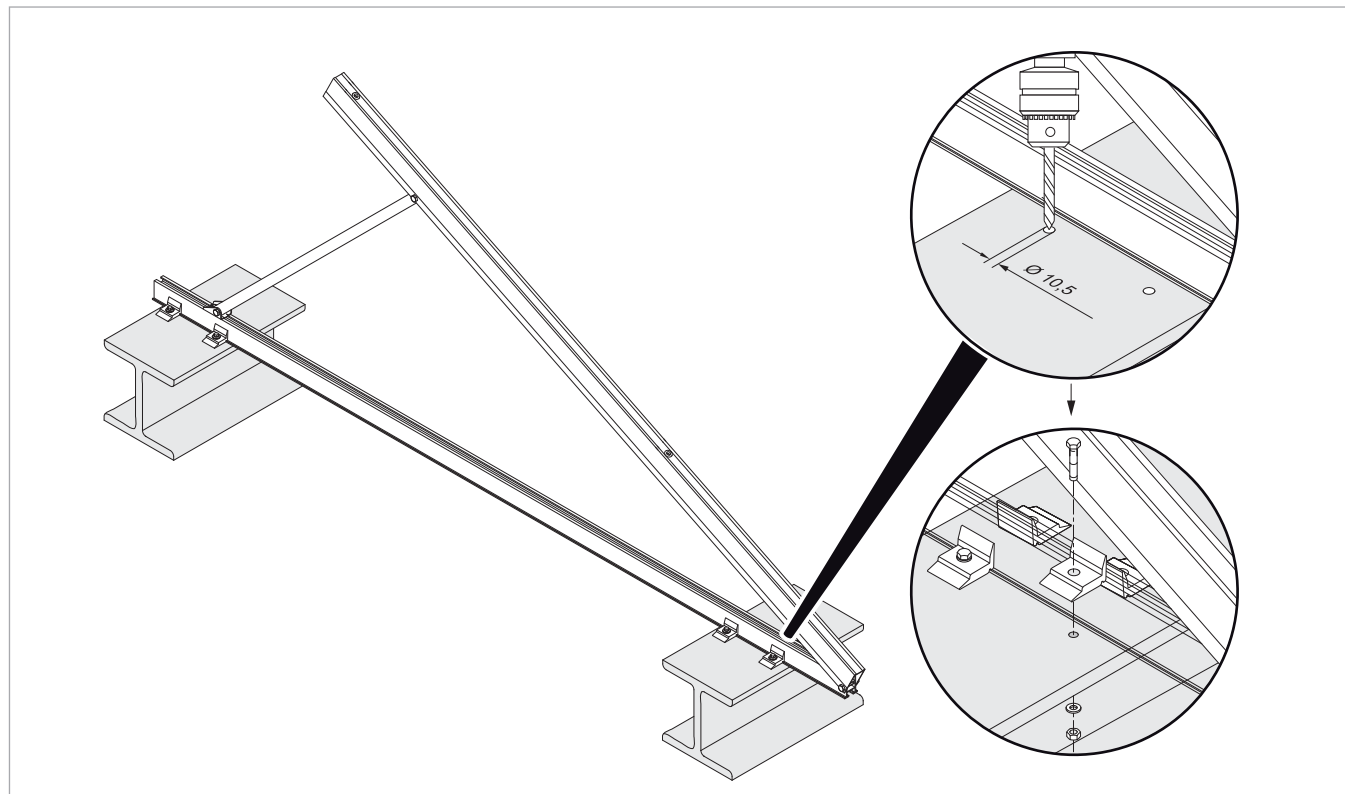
montage du montant pour toit plat sur poutres en acier
